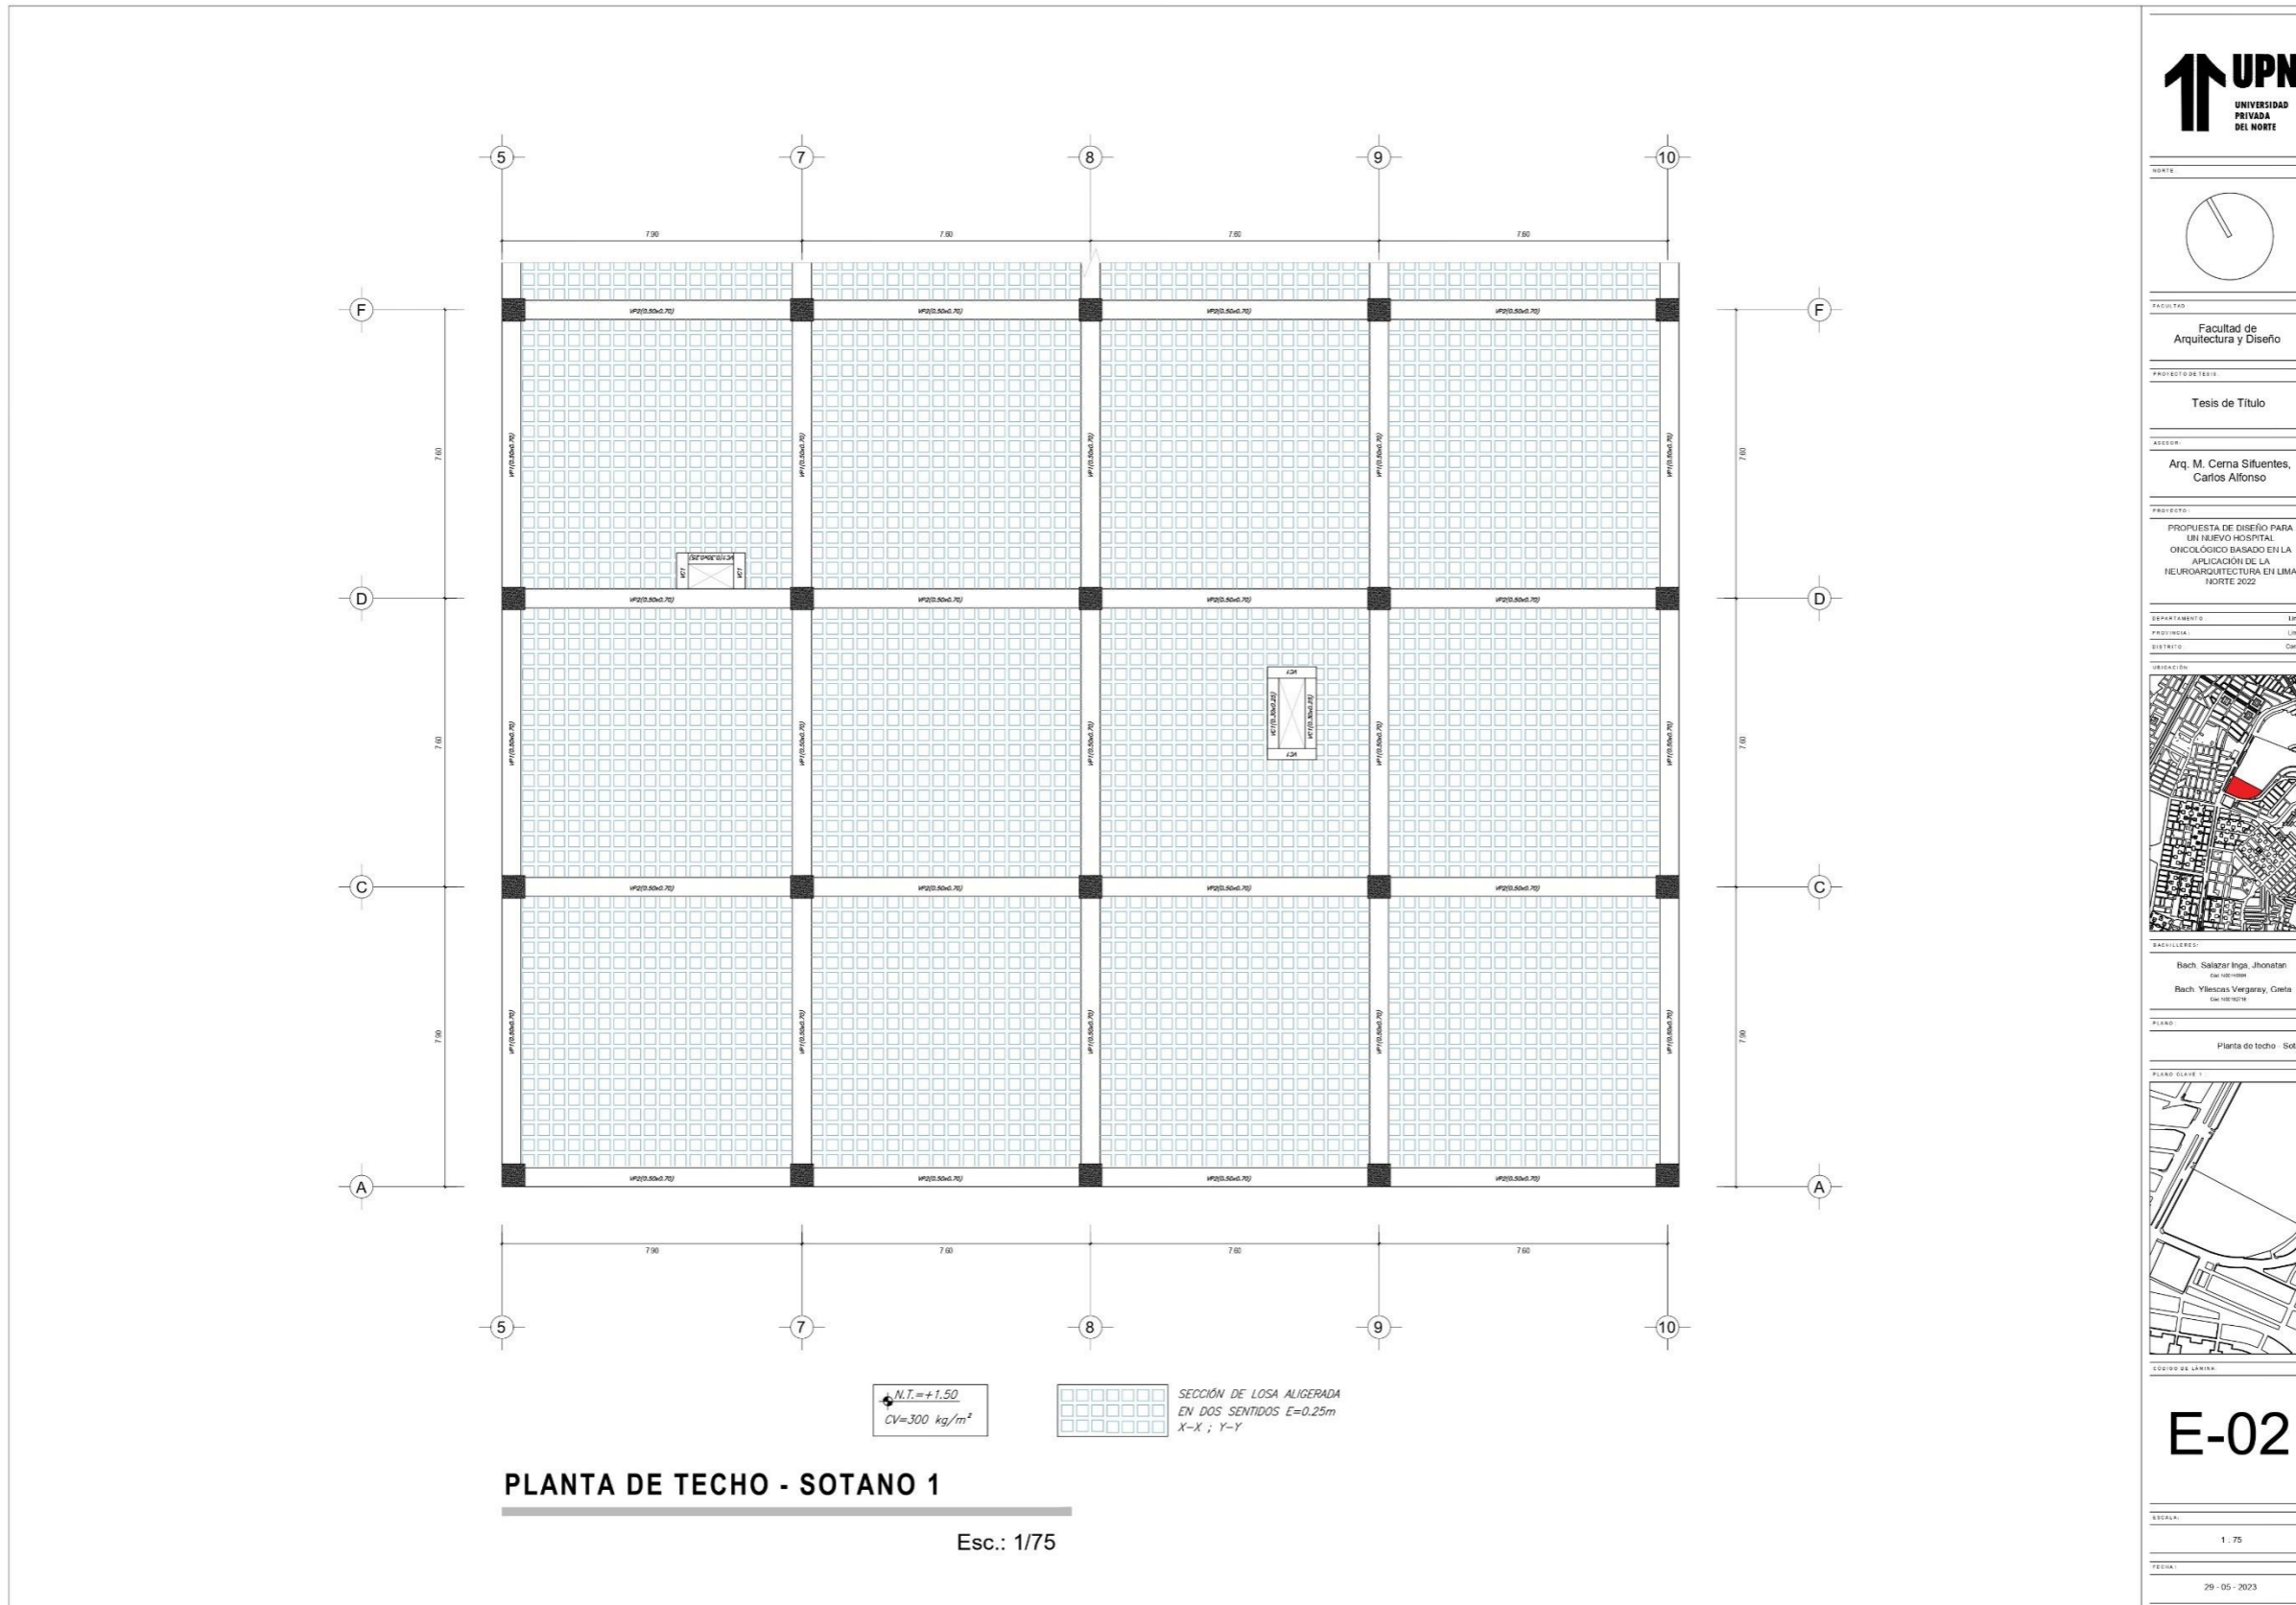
Estructuras – Aligerado planta de techo Sótano N°1 del sector cuadrante Esc: 1/75 (Fuente: Elaboración propia de los coautores)
